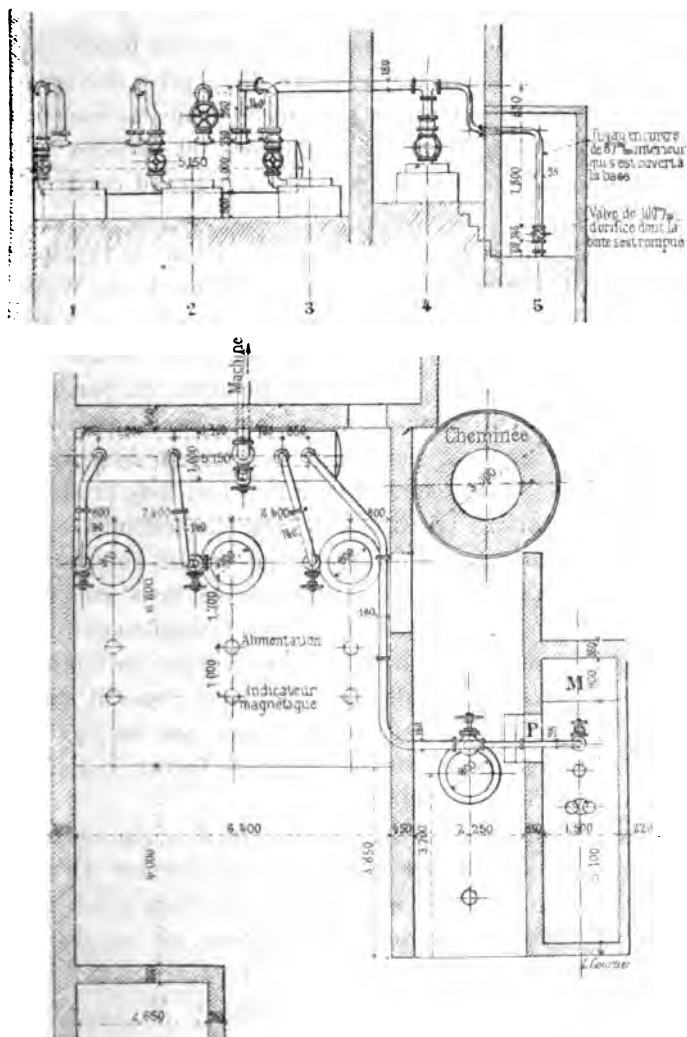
et 5. — Coupe et plan de l'installation, à Tourcoing.
